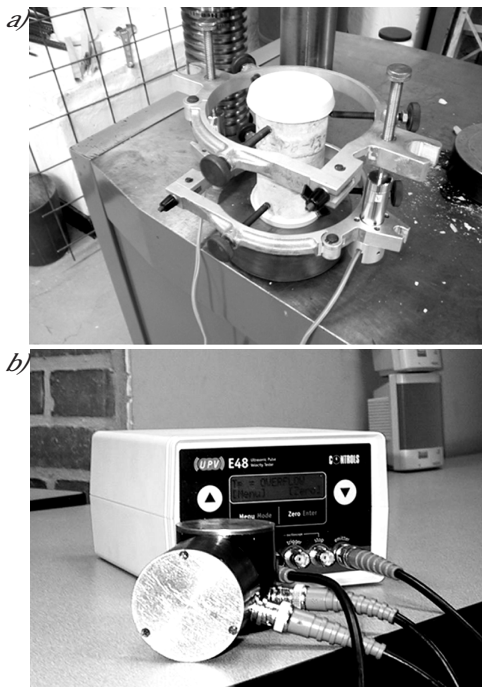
a) Colocación de la muestra obtenida como núcleo tomado directamente de la estructura, y lista para ser fallada en la maquina universal. b) Aparato ultrasonido utilizado.
